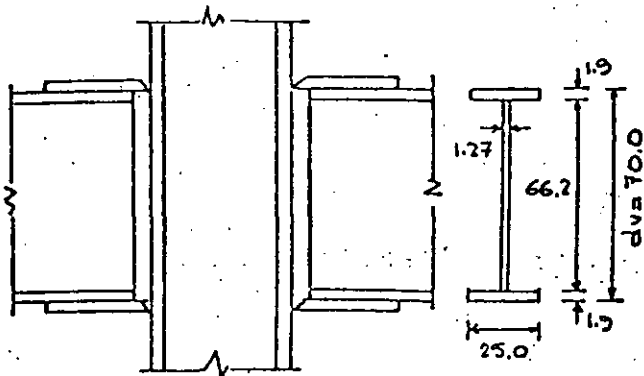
FIGURA. TANTO LA COLUMNA COMO LAS VIGAS ESTÁN HECHAS CON TRES PLACAS
